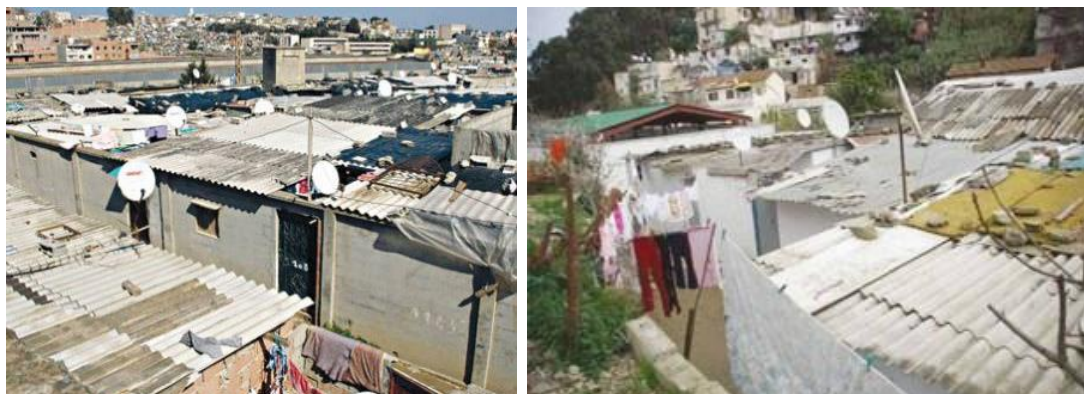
et II-7: exemples de bidonvilles réalisés en parpaing avec des toitures en tôle (source : <http://www.dknews-dz.com/>. URL <http://www.dknews-dz.com/article/73670-constantine-resorption-de-lhabitat-precaire-des-efforts-colossaux-pour-tourner-la-page-des-bidonvilles.html>)
